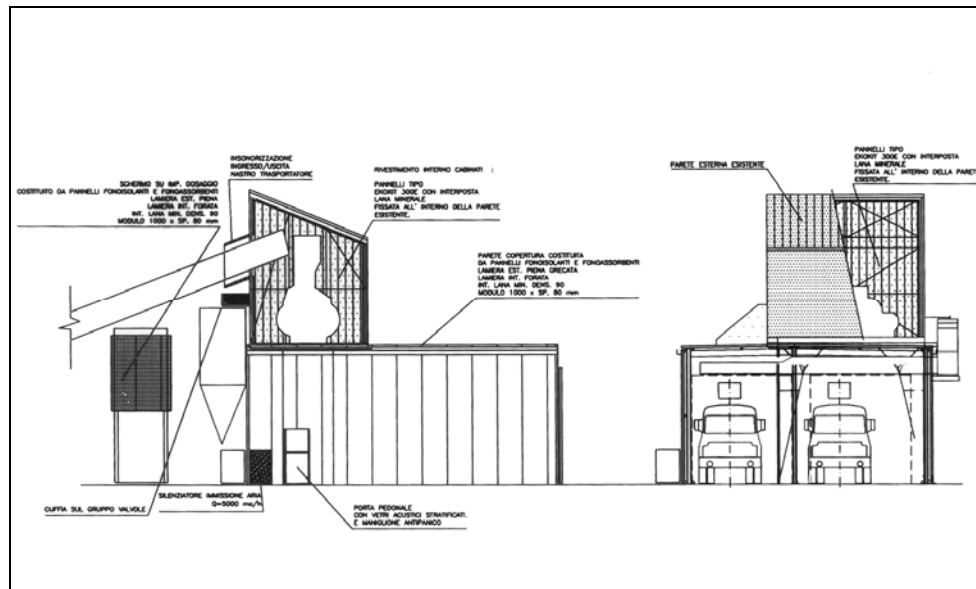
Sezione insonorizzazione impianto di betonaggio.
